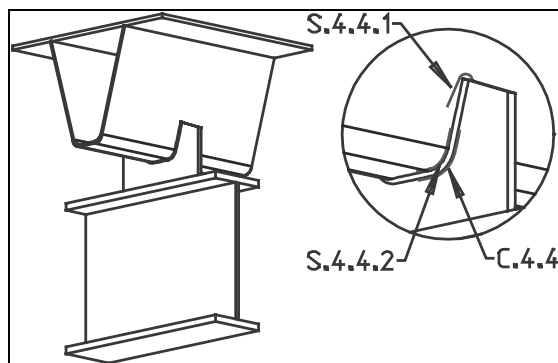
Durchgehende Trapezsteife mit ovaler Aussparung
